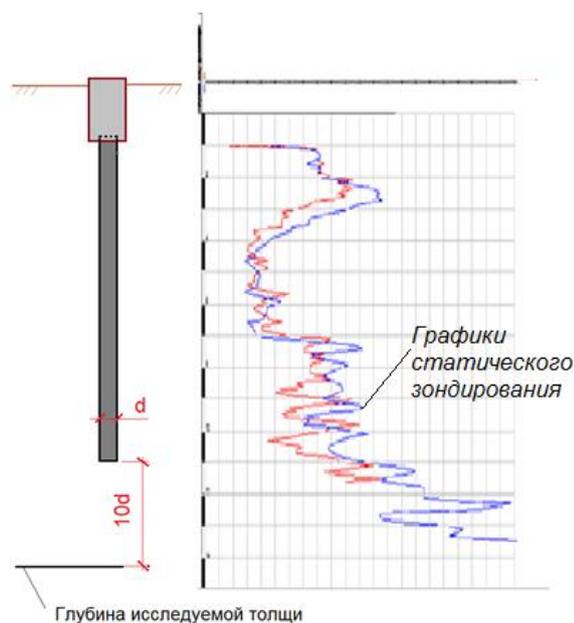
Определение глубины исследуемой толщи для свайного фундамента
